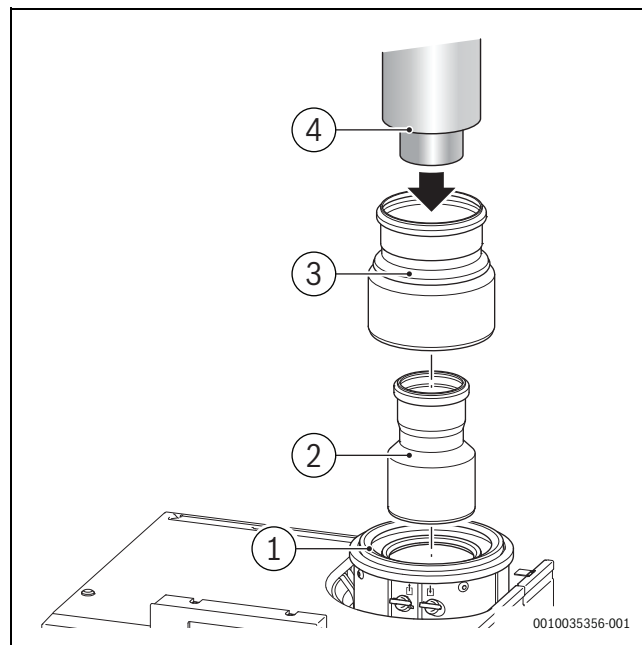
Установка адаптера дымовых газов Ø 80/125
